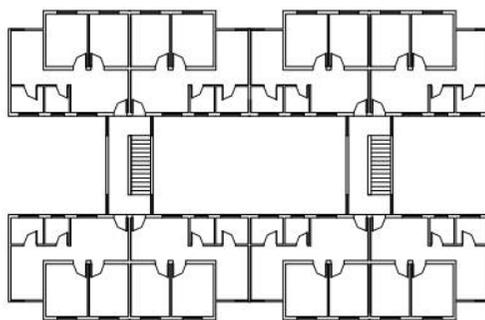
Planta baixa (Edifício de apartamentos padrão)
